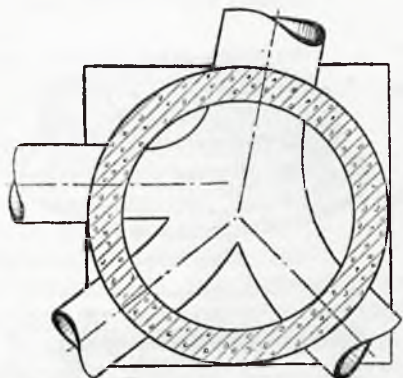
Studzienka włazowa z cegły (Warszawa)
